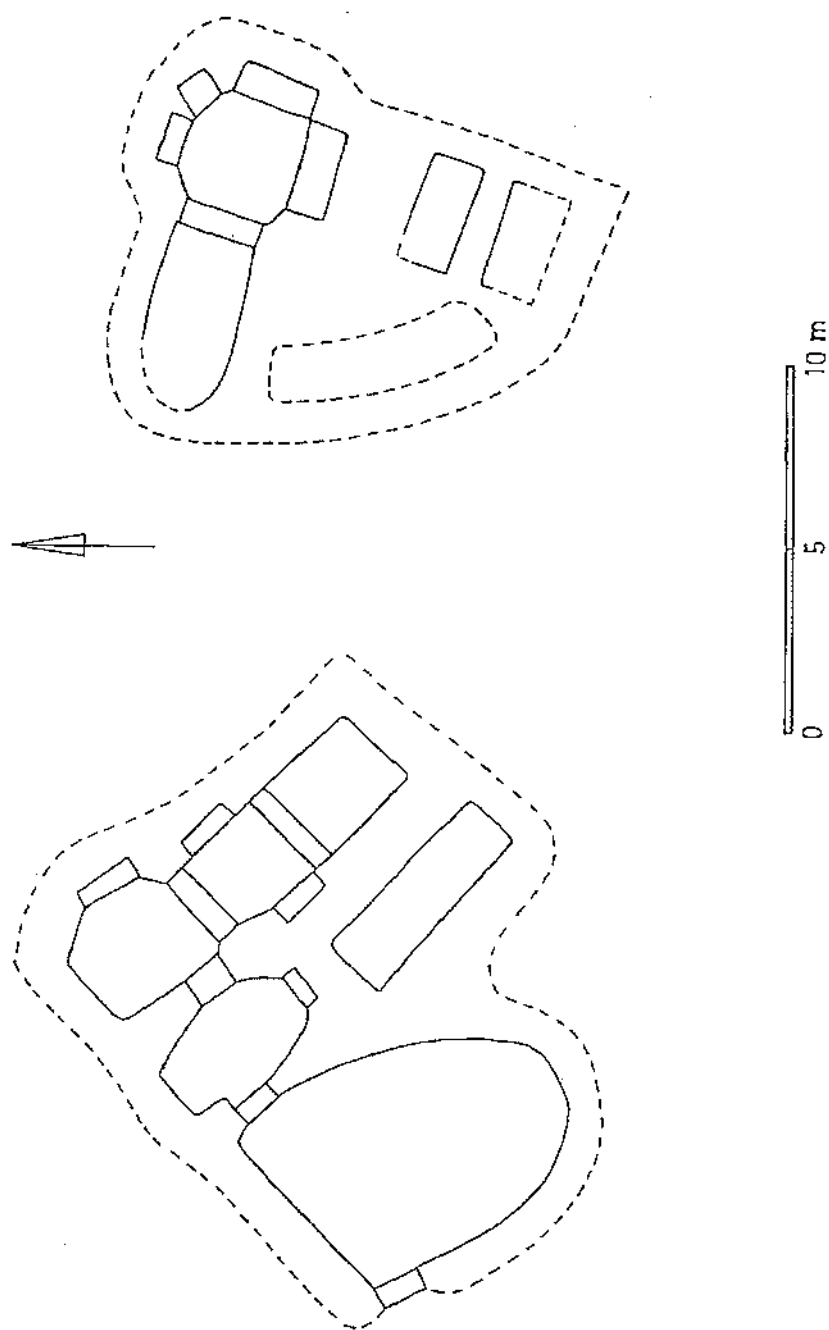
Gewölbte Häuser mit unregelmäßigen Grundrissen
